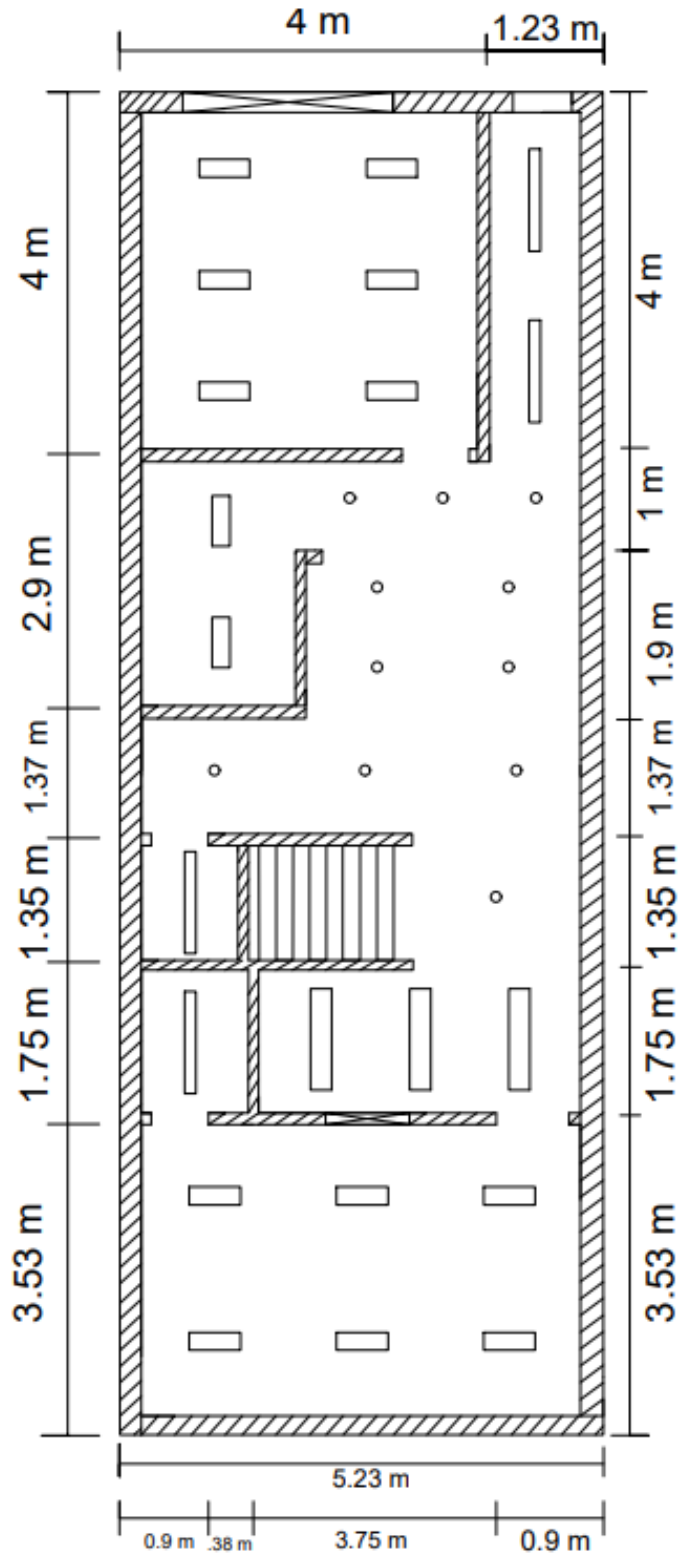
Plano de distribución de luminarias en la planta baja propuesta 1
